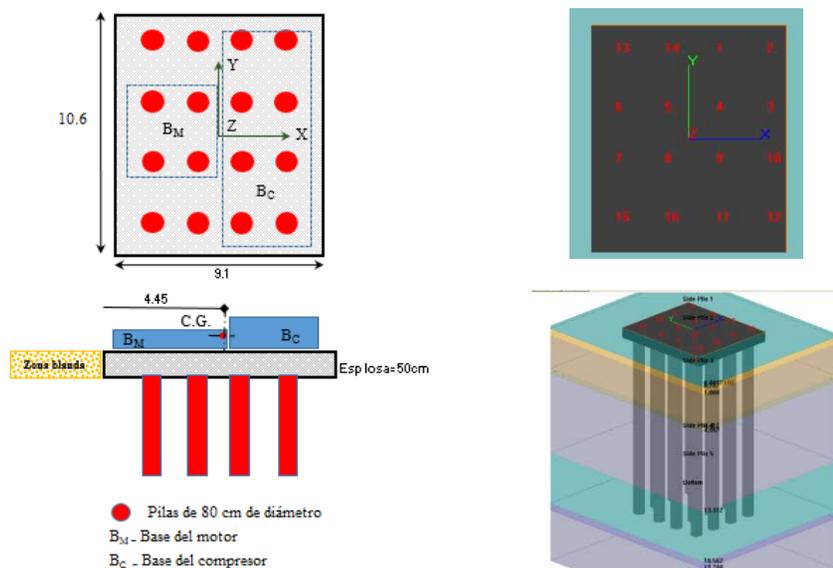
Arreglo general de cimentación y pilas para el compresor recíprocante.
